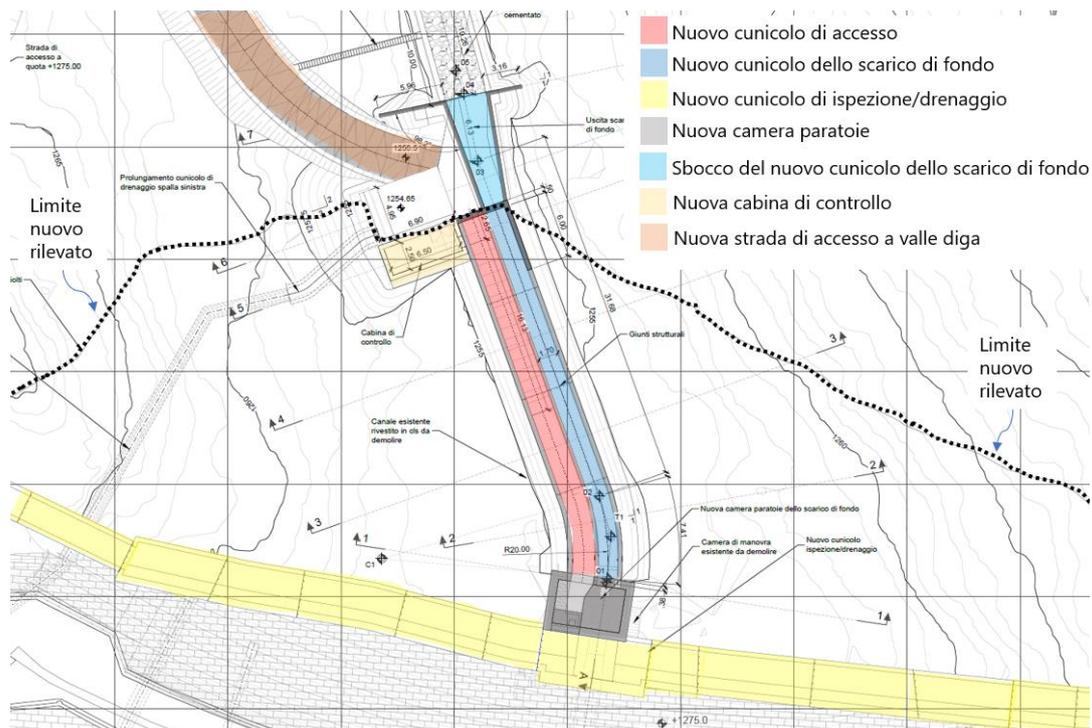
nuovo cunicolo di accesso e scarico di fondo, pianta
